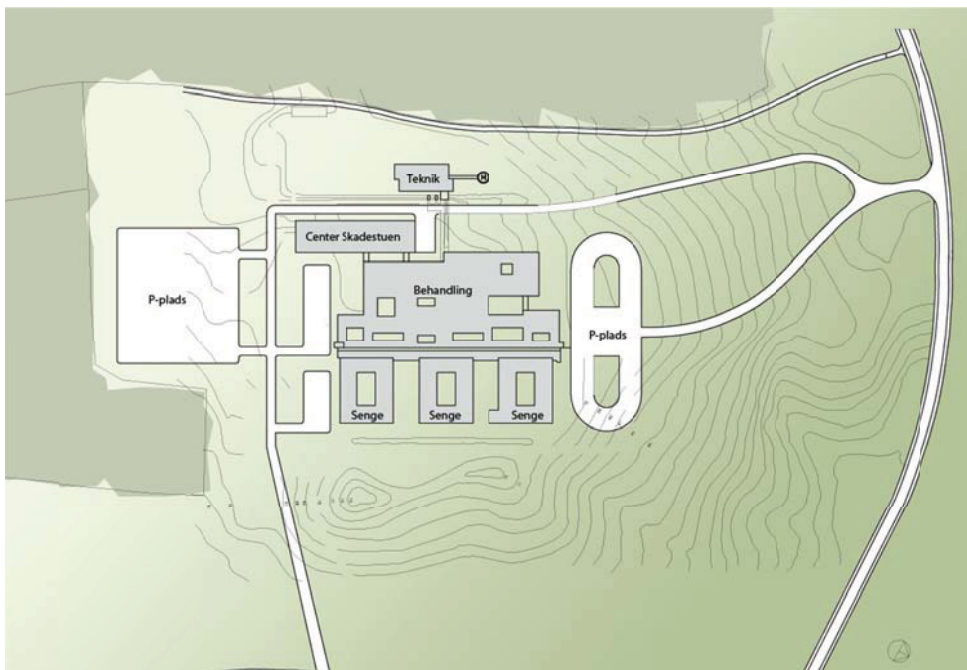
Planimetria generale dell'ospedale prima delle fasi di ampliamento.
